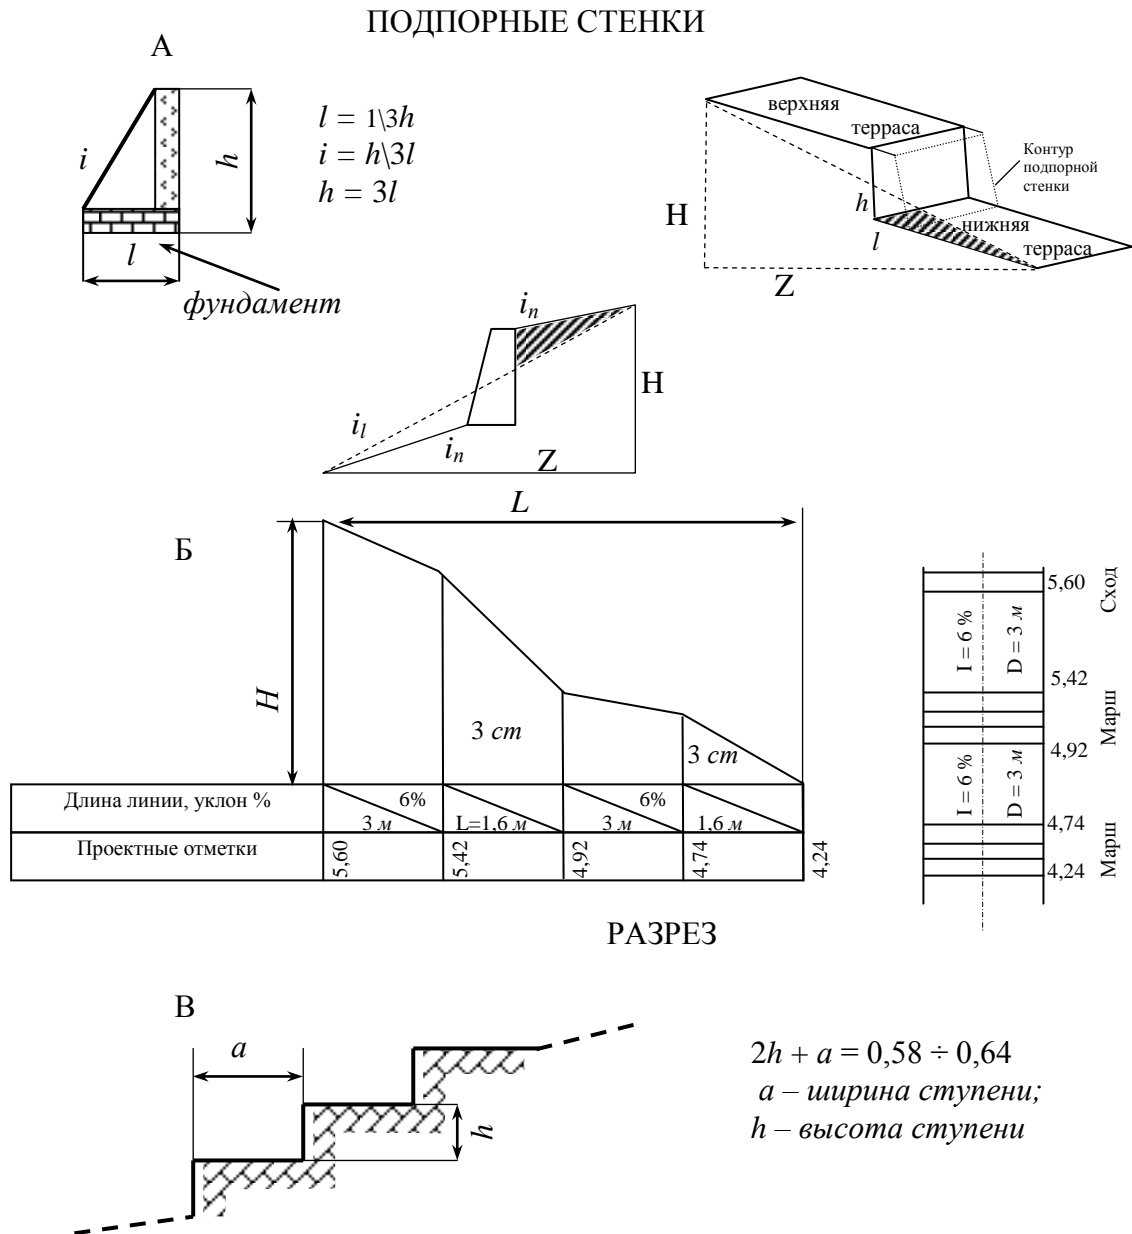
Схемы, показывающие проектные решения подпорных стенок и лестниц: А - подпорная стенка, устраиваемая на перепаде рельефа с организацией террас; Б - изображение плана и продольного профиля лестницы, проектируемой на склоне с уклоном в 60 % (6%); В - элементы лестницы.
